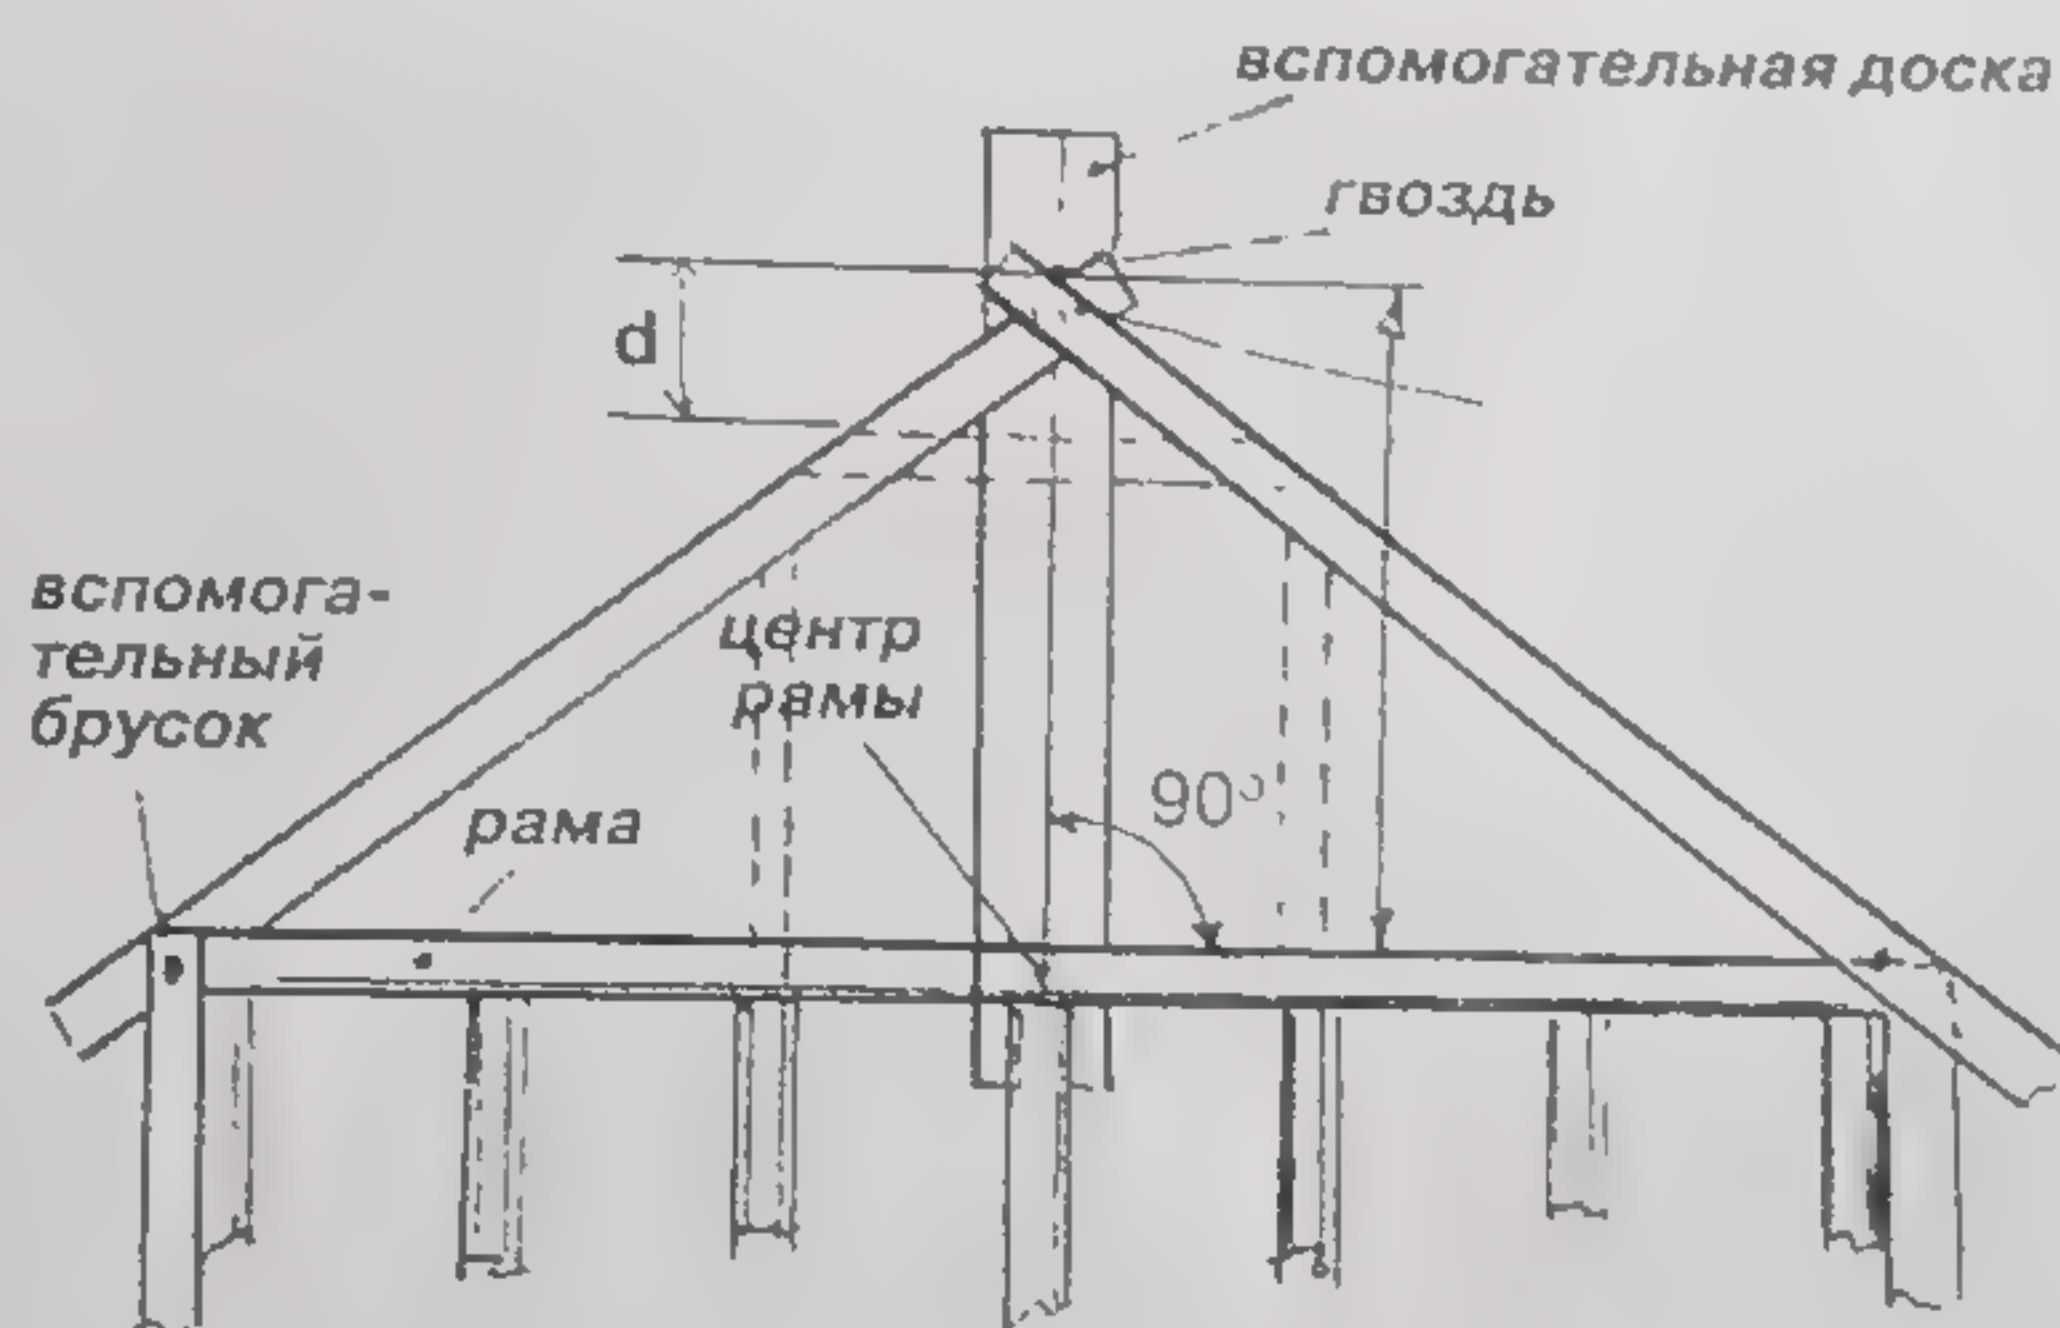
Разметка стропил для крепления конькового бруса, где d — диаметр.
